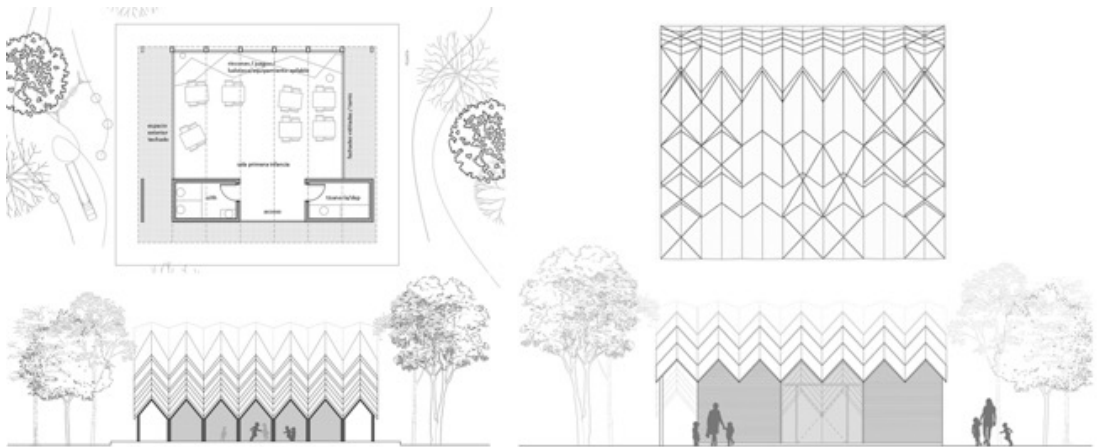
PLANIMETRÍA DEL AULA PARA LA PRIMERA INFANCIA. A) PLANTA BAJA. B) PLANTA DE CUBIERTA. C) FACHADA POSTERIOR. D) FACHADA FRONTAL.
